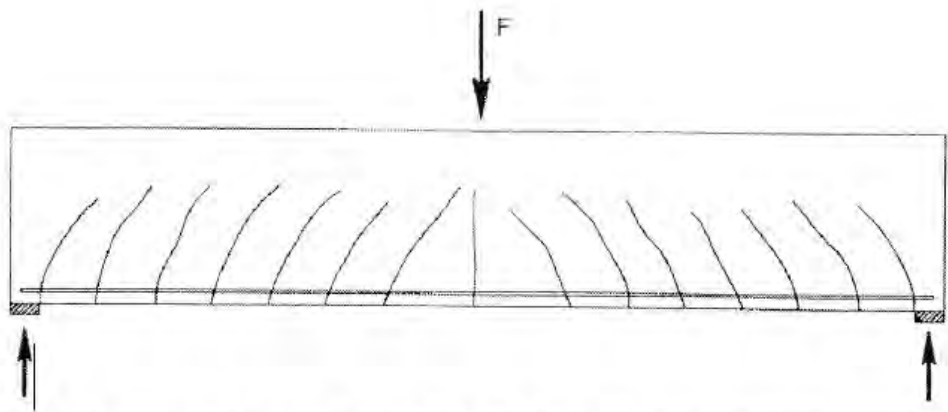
Truss analogi untuk balok beton bertulang sesuai Morsch
